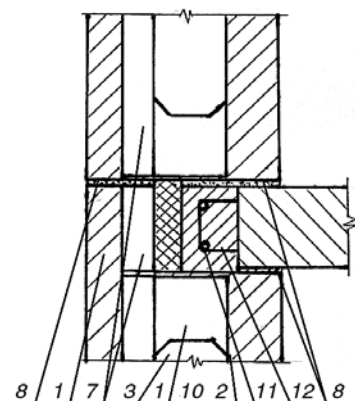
Вариант исполнения горизонтального стыка между панелями цокольного и 1-го этажей с наружным и внутренним несущими слоями. Навесной фасад условно не показан: 1 – наружный несущий слой; 2 – внутренний несущий слой; 3 – утеплитель; 4 – связи; 6 – вуты; 7 – ребра; 8 – растворный шов; 9 – гидроизоляционный участок; 10 – утепляющий вкладыш; 11 – монолитный железобетонный участок с непрерывной горизонтальной арматурой; 12 – тепловые выпуски из плит перекрытия
